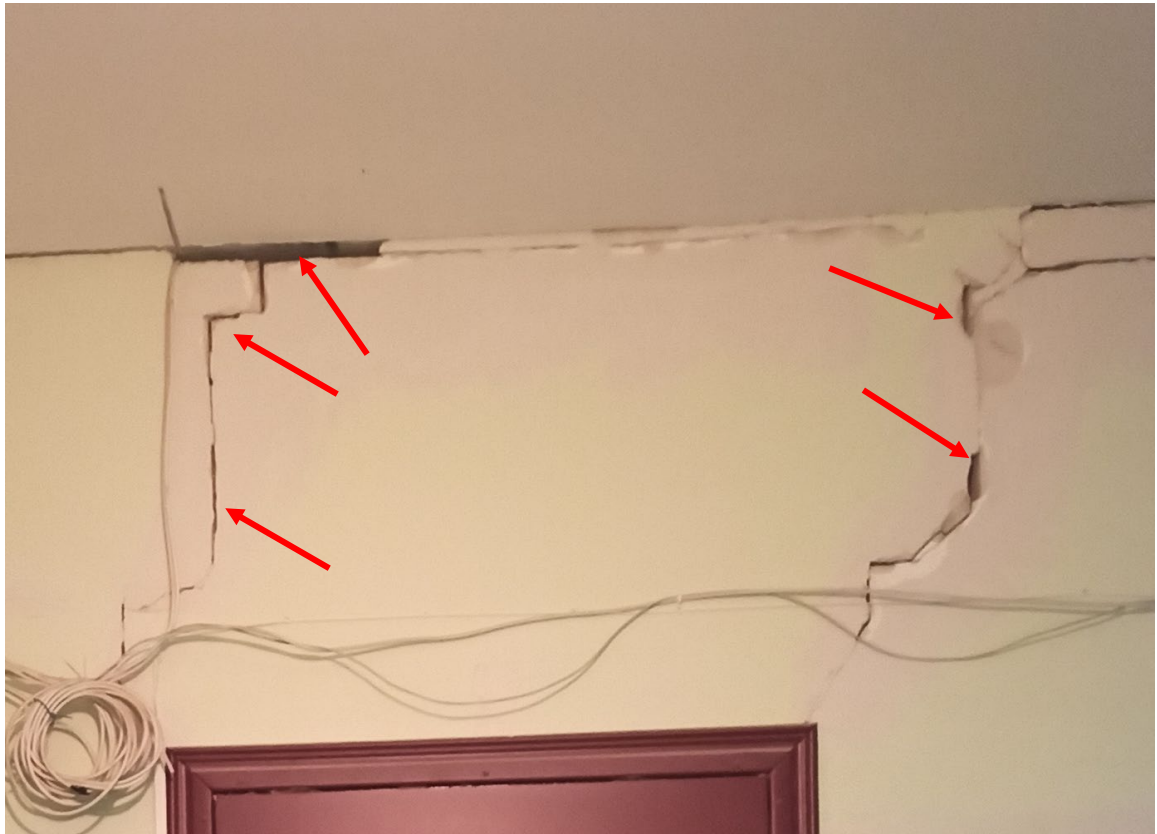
Выкрашивание раствора из шва в месте сопряжения внутренней стены с плитой перекрытия и из швов пазогребневых плит внутренней стены второго этажа.
